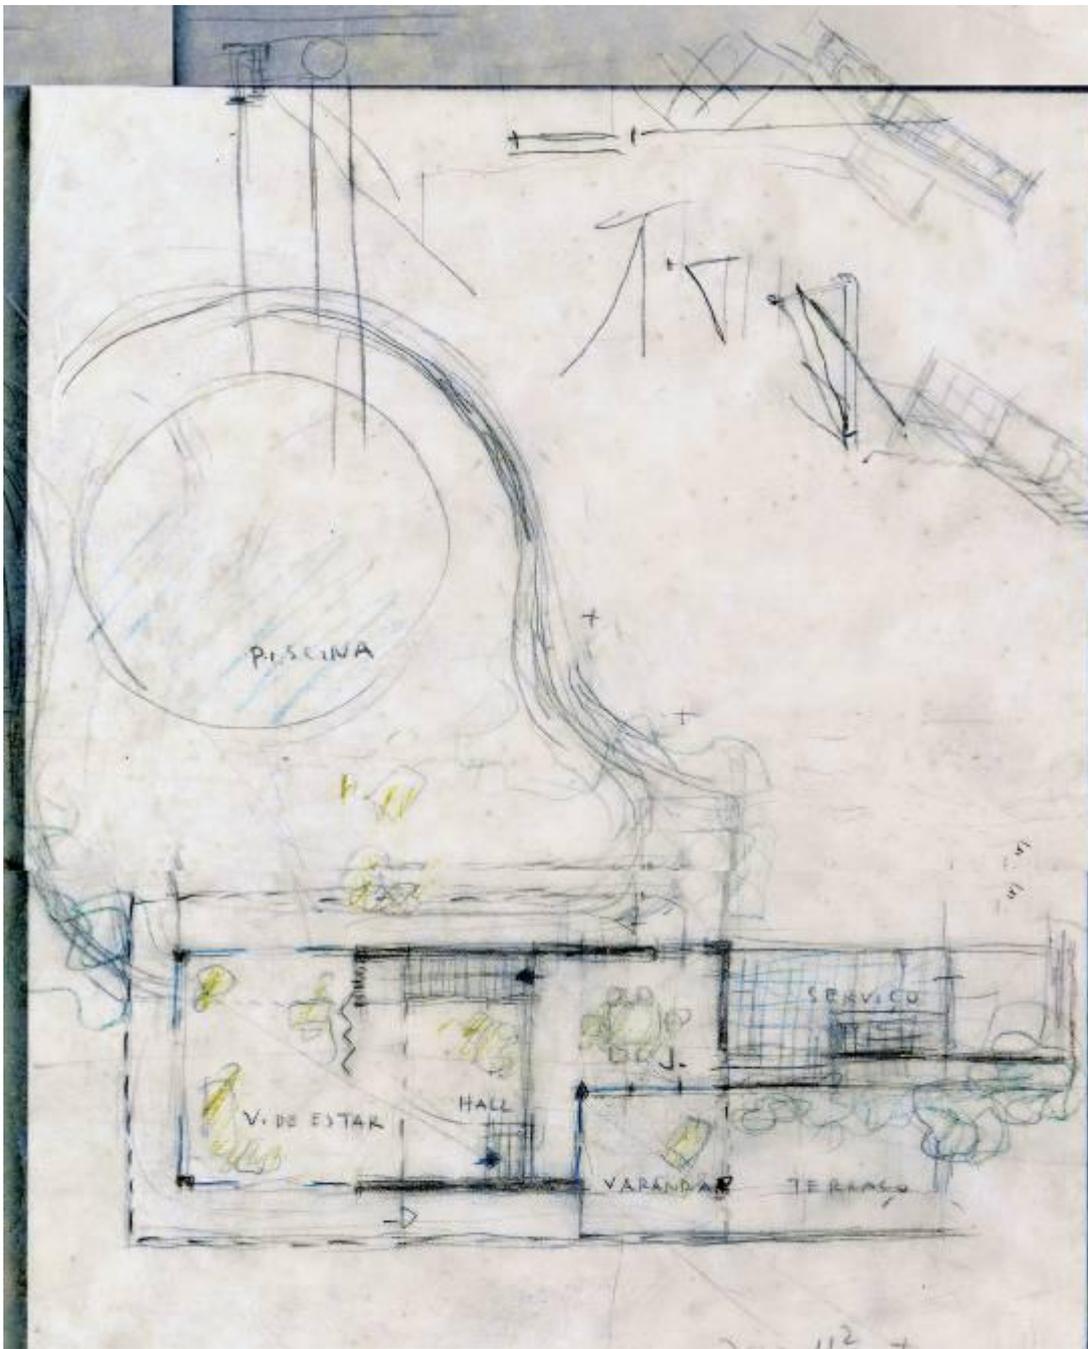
Estudo para o pavimento térreo do Park Hotel com piscina redonda. (Grafite e lápis de cor sobre papel manteiga. 50x35cm)
